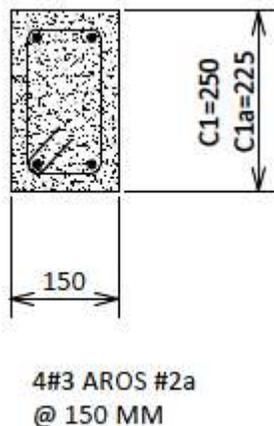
Detalles de columnas del kinder. Fuente: Constructora.
